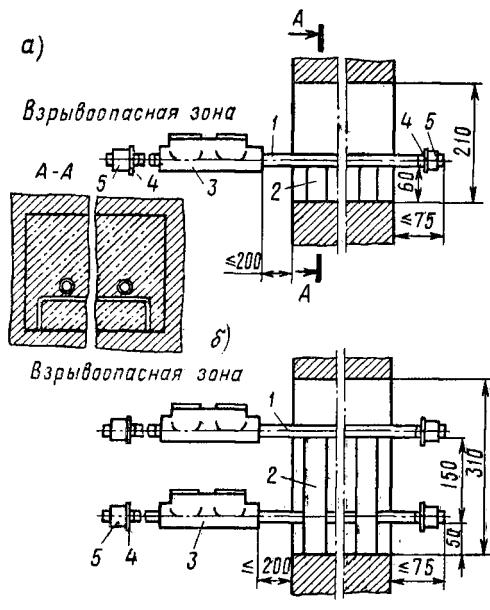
Разводка трубопроводов осветительной сети в помещениях со взрывоопасными зонами:
